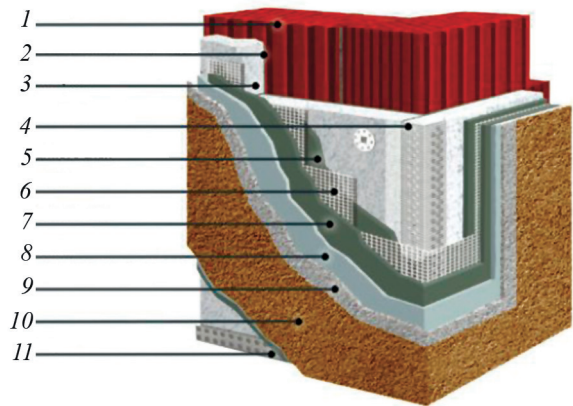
Опорядження фасаду акриловою або мінеральною штукатуркою:
